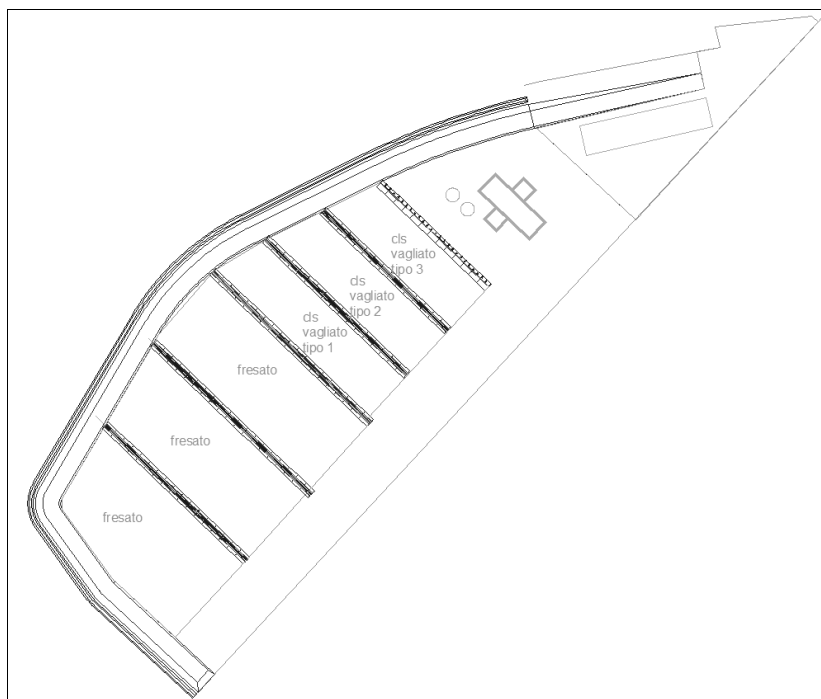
Planimetria generale dello stato di progetto. Schema delle vasche in cls in progetto (prima fase).
